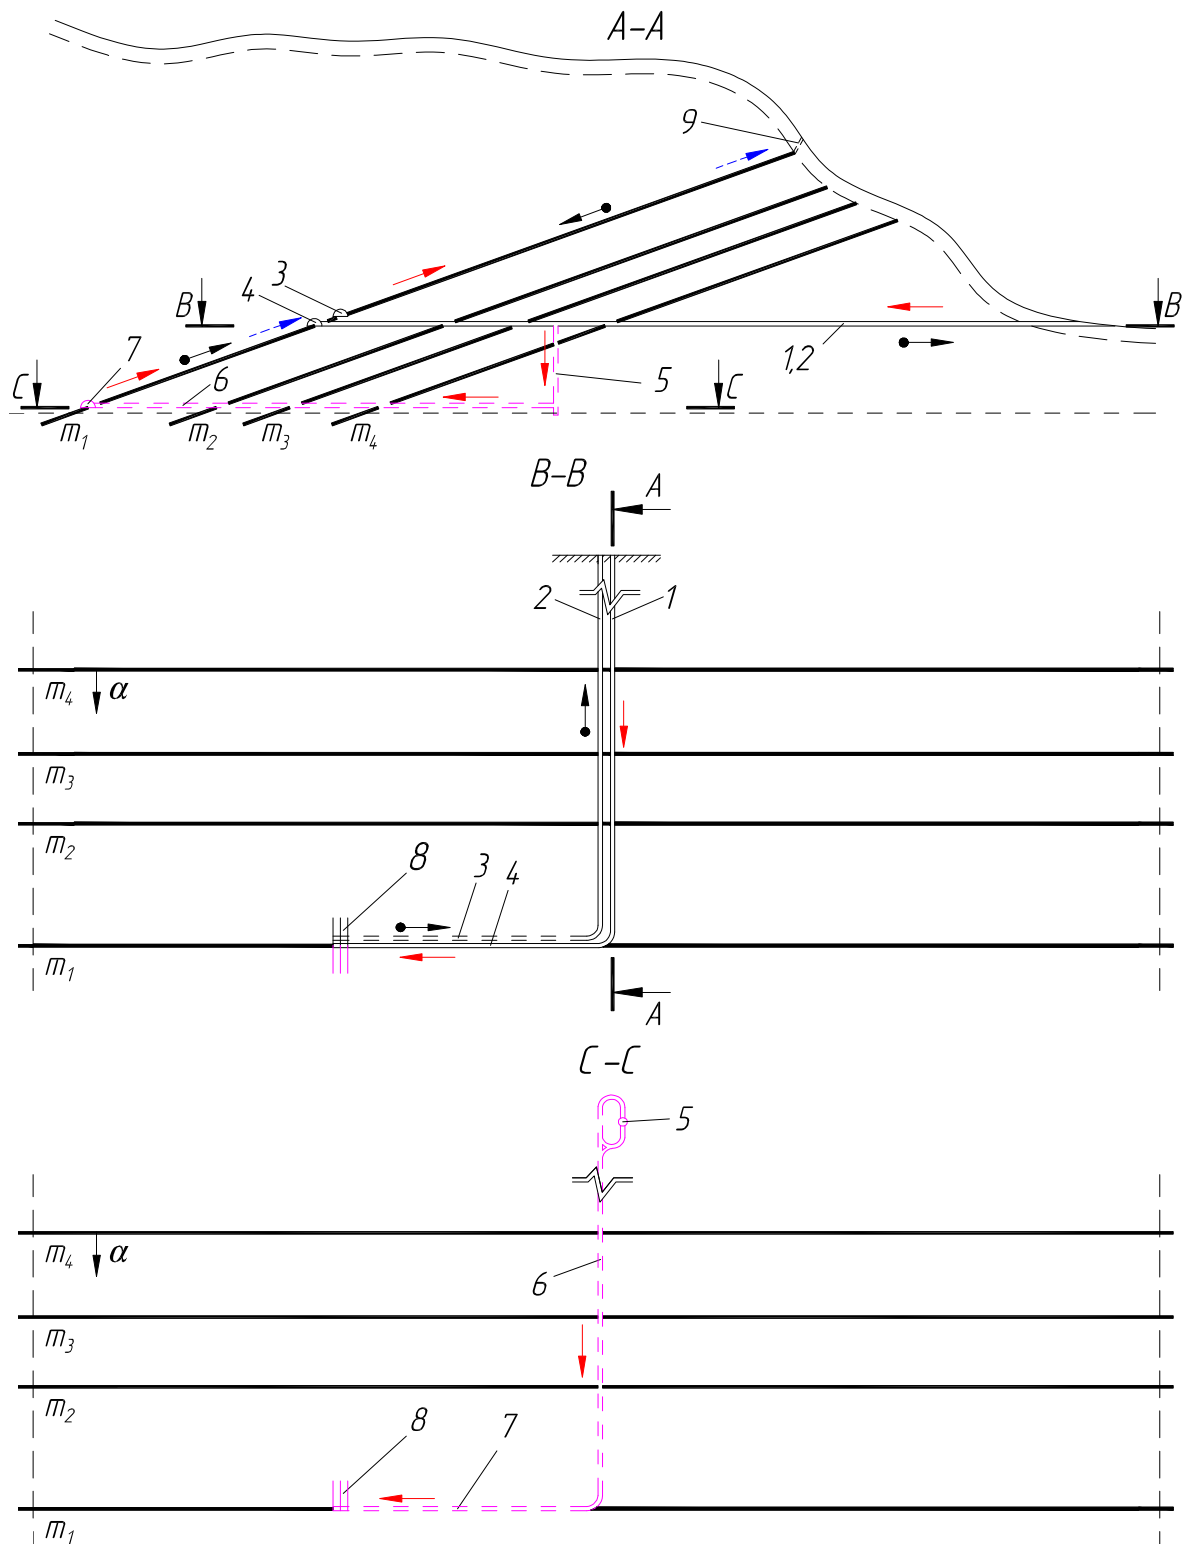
Комбинированная схема вскрытия штольнями и слепым стволом:
